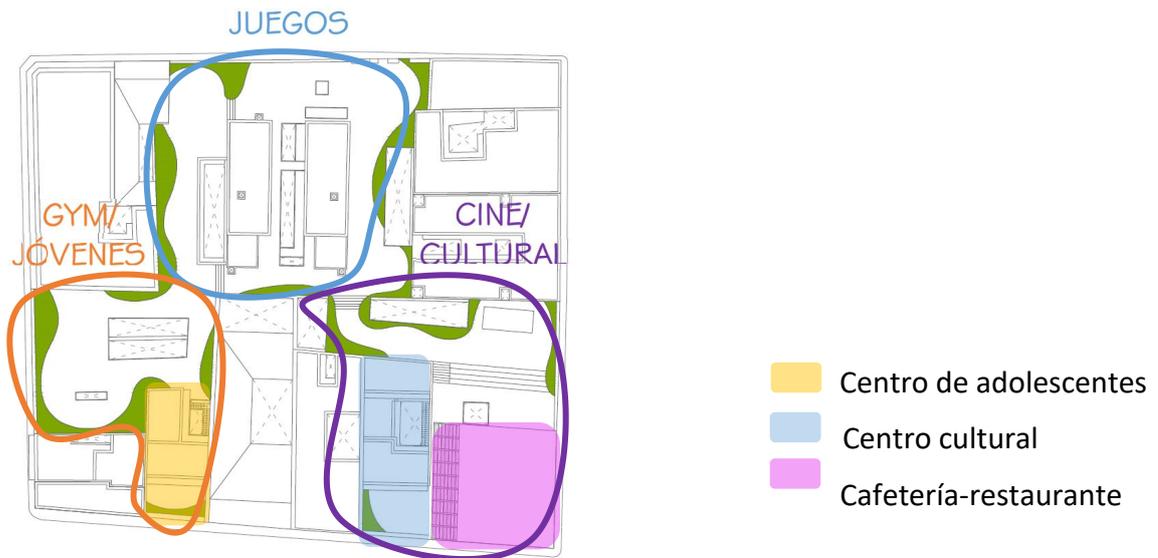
Plano de cubierta con la distribución de las 3 zonas propuestas. Fuente: Elaboración propia.
